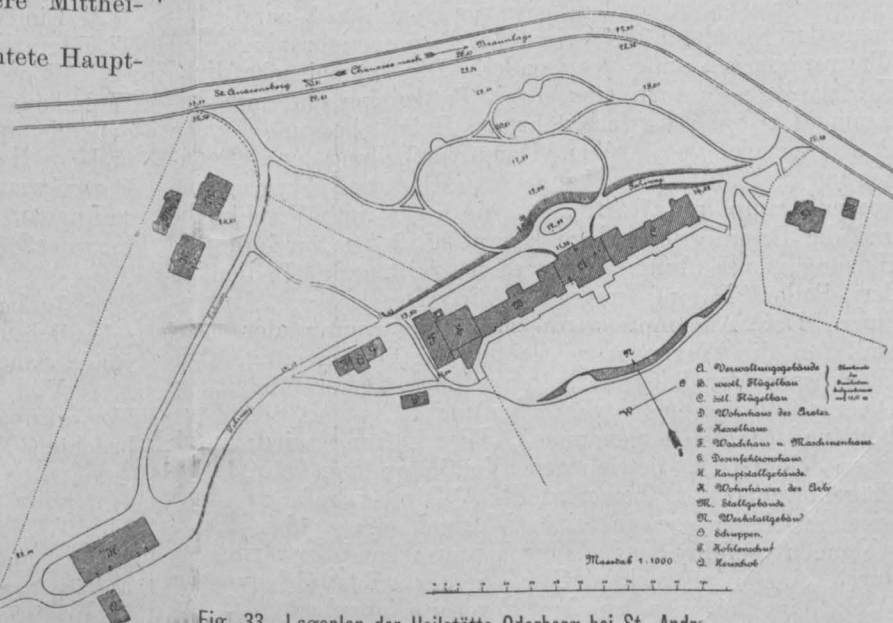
Lageplan der Heilstätte Oderberg bei St. Andr.
